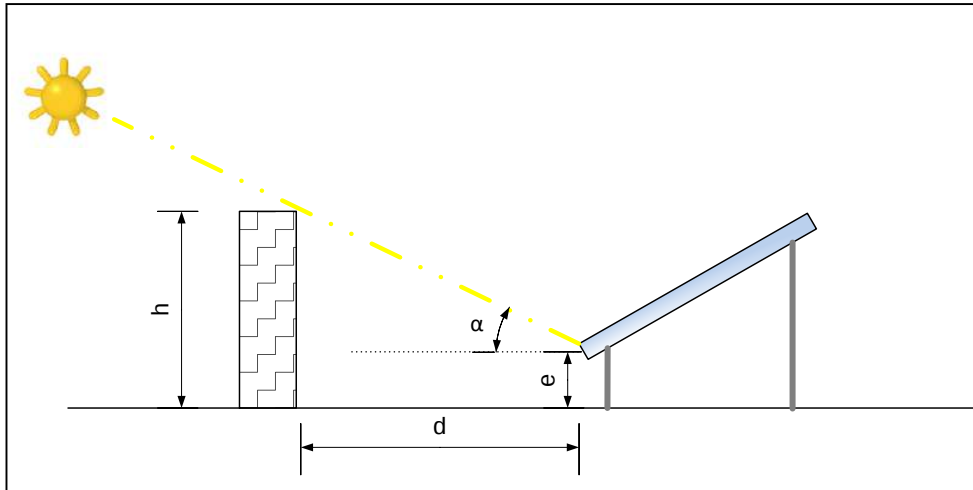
distance de retrait par rapport à un obstacle (acrotère, murette, etc.)
